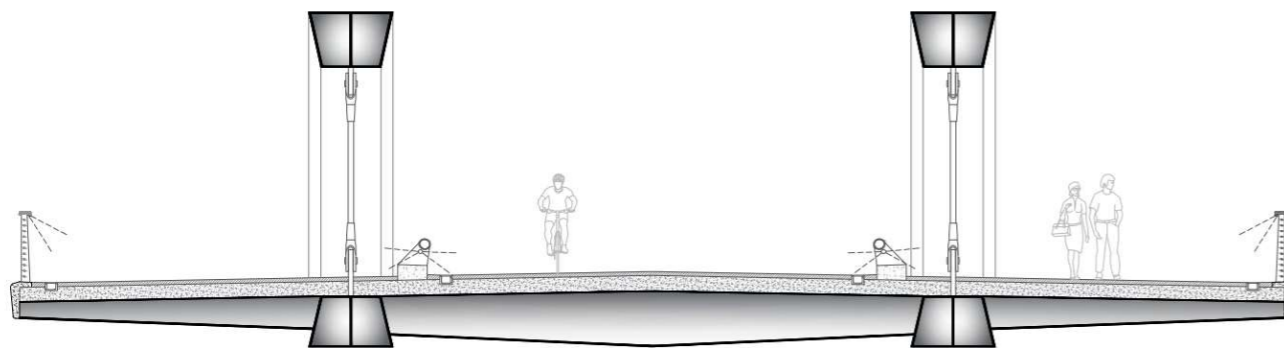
Sección transversal del puente (fuente: elaboración propia)
